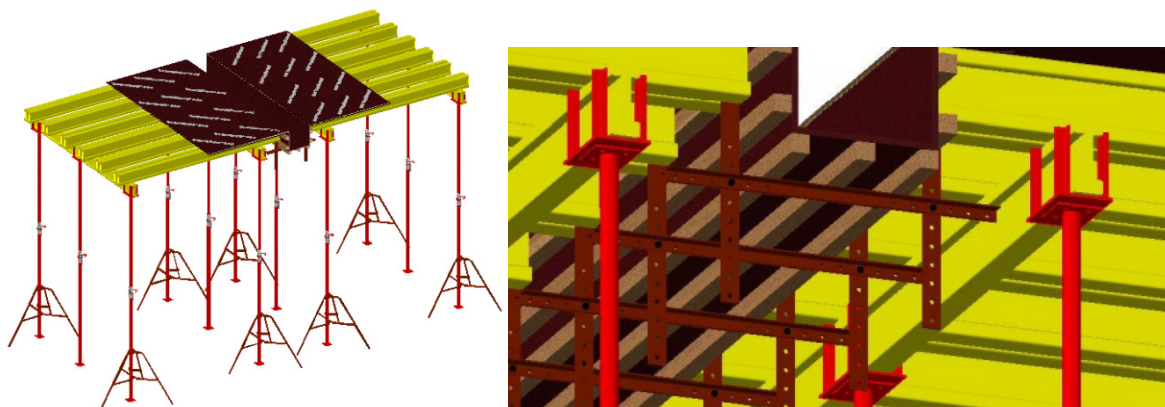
Опалубка перекрытий с использованием струбцин
